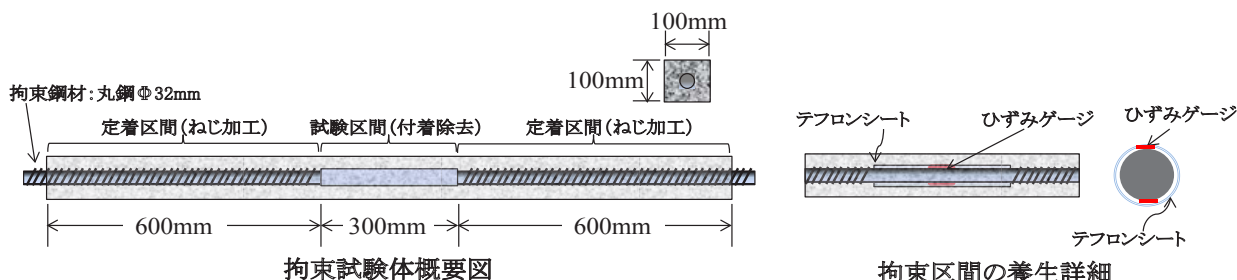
ひび割れ抵抗性試験用コンクリート供試体の概要
